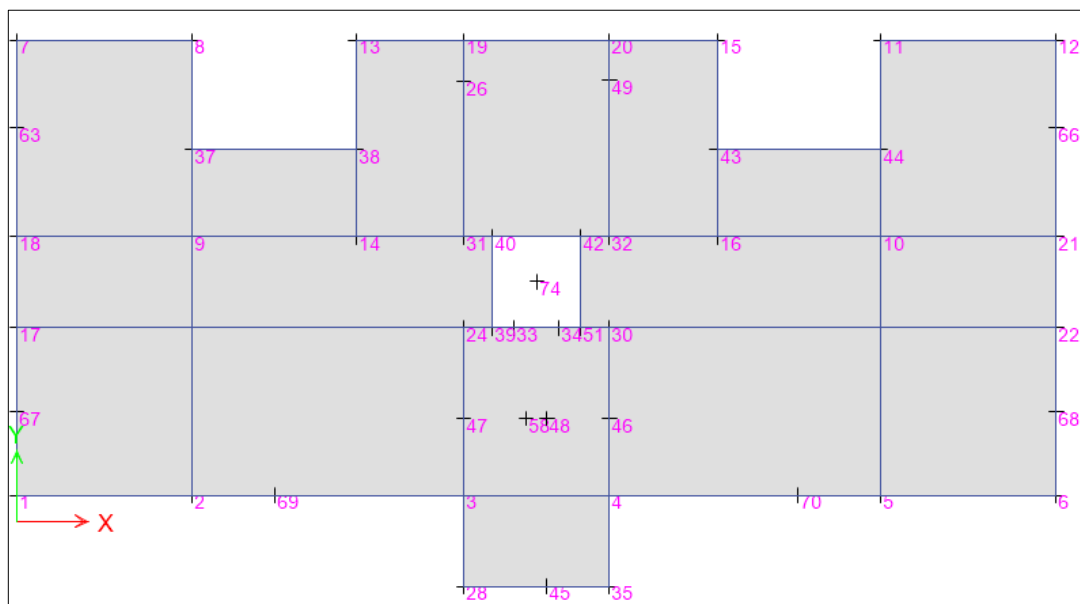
Distribución de las etiquetas en los apoyos del modelo para departamentos
